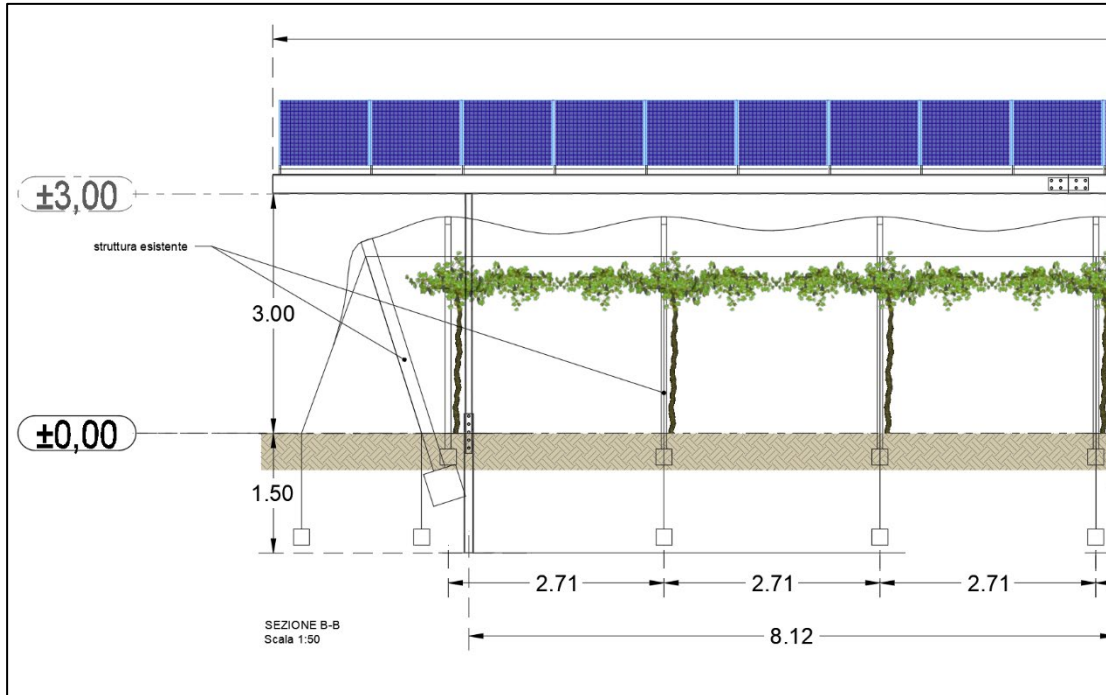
Particolare costruttivo sezione trasversale delle strutture fisse di supporto
